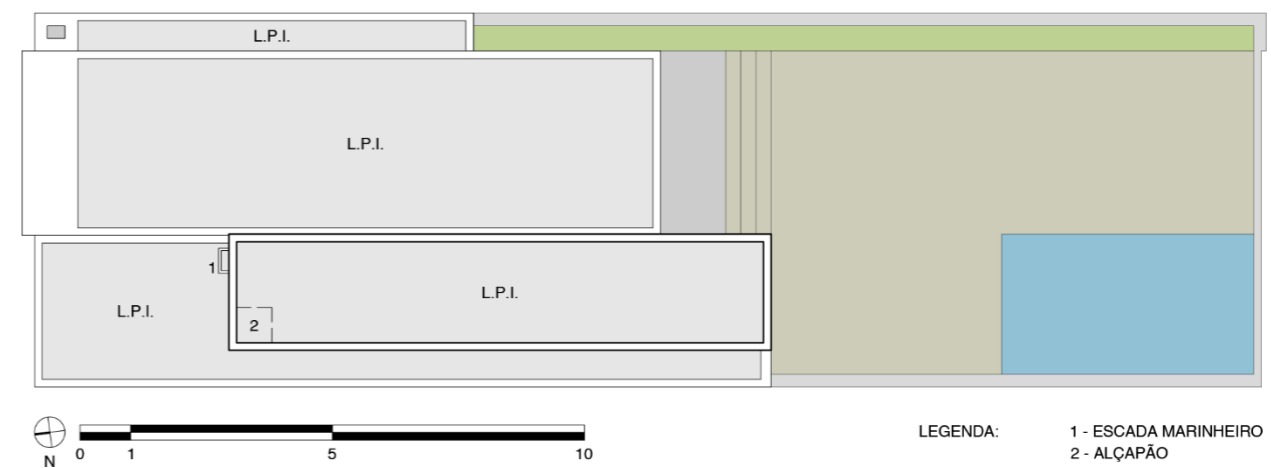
Planta de cobertura do Residencial Flor de Liz
